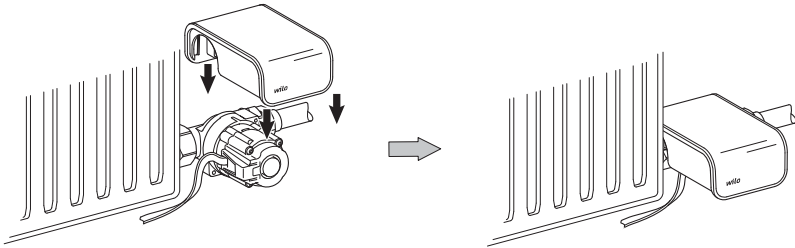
Verkleidung auf Heatfixx Pumpe/Pumpenadapter aufstecken
